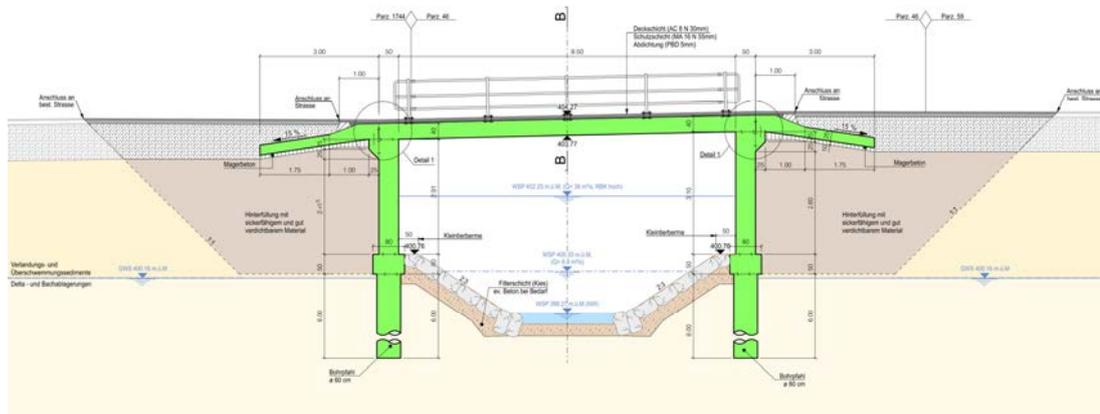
Vertikale Linienführung der Brücke Rheinstrasse, Littenbach
